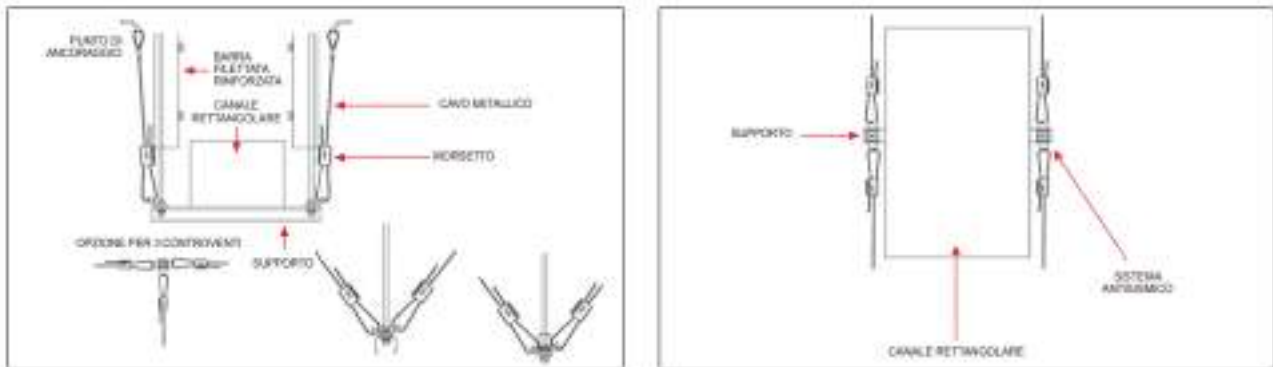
Controvento longitudinale – vista trasversale e planimetrica
